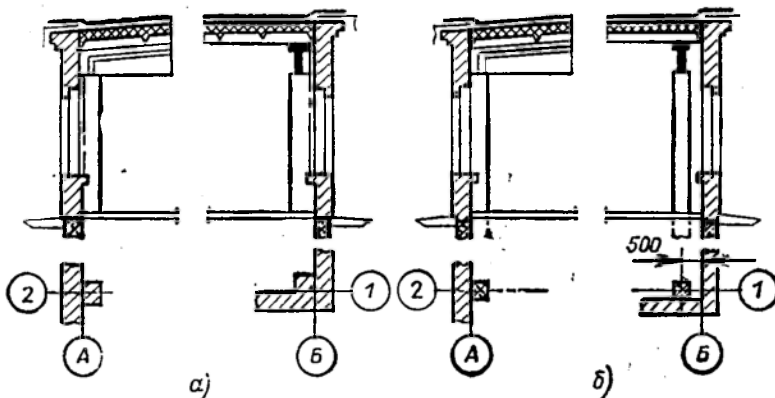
Привязка элементов здания к разбивочным осям бескрановых зданий:
